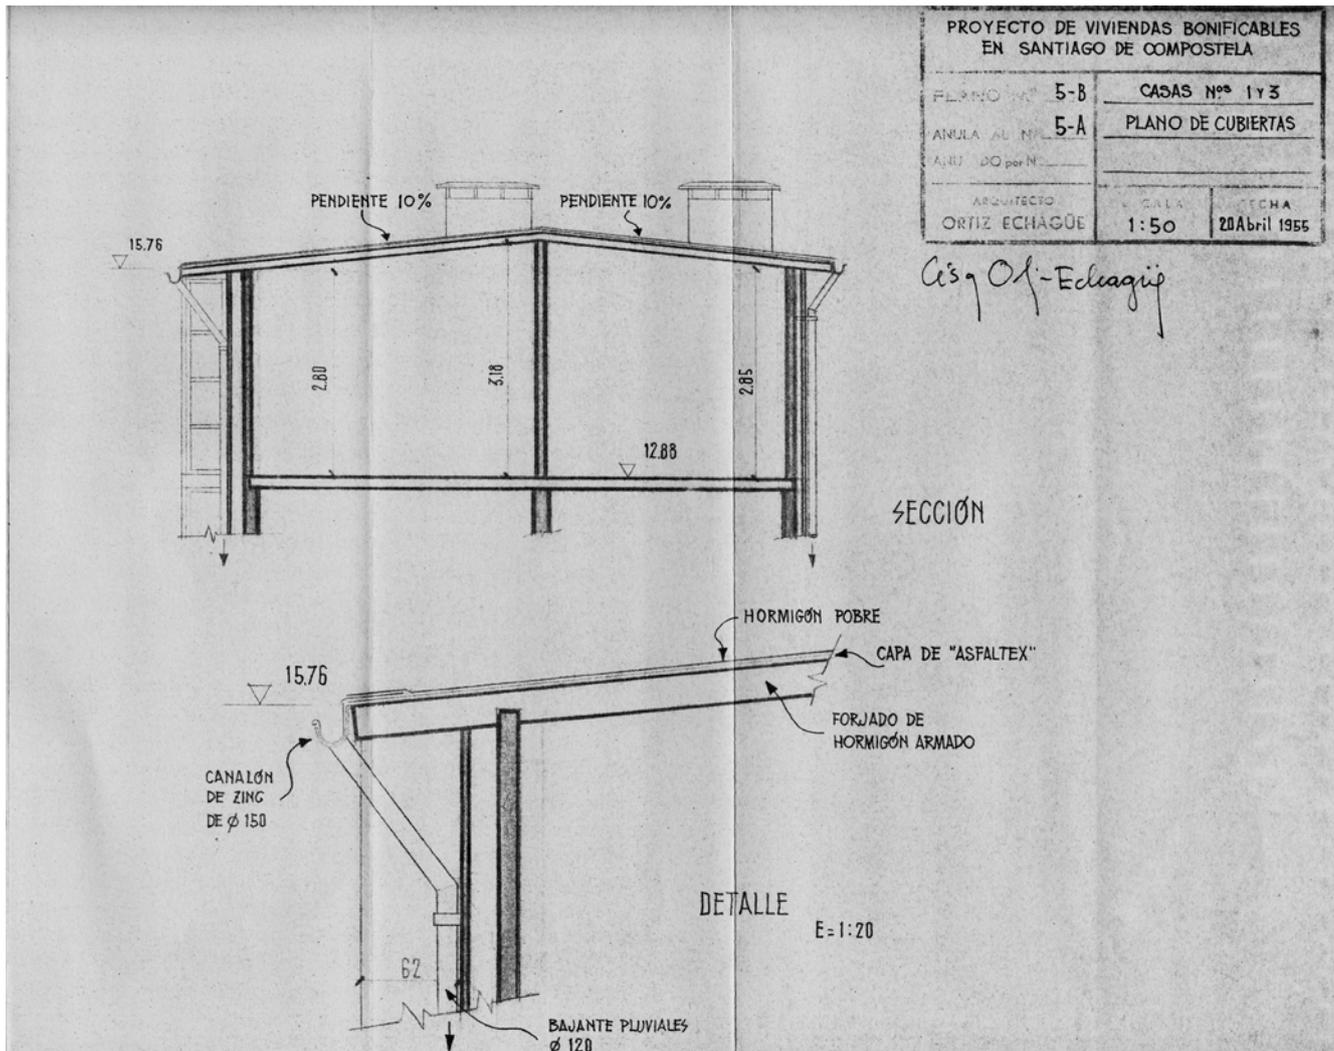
Plano Nº 5-B, abril 1955. Plano de Cubiertas: Pormenor de Sección y Detalle vertical de las casas Nº 1 y 3.
